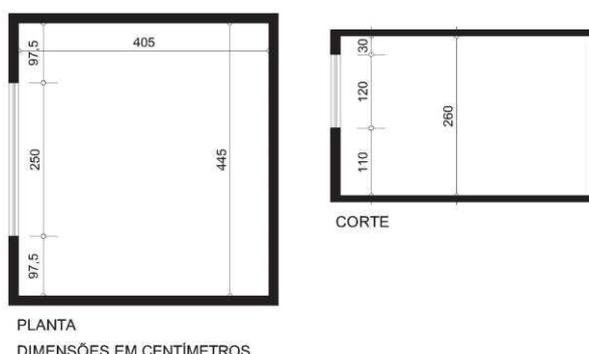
Planta e corte com dimensões da sala do modelo do Buritis.
